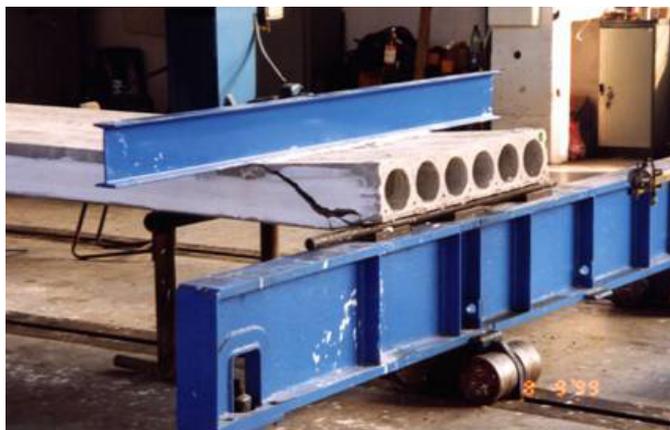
Spannbeton-Fertigdeckenplatte im Schubversuch
